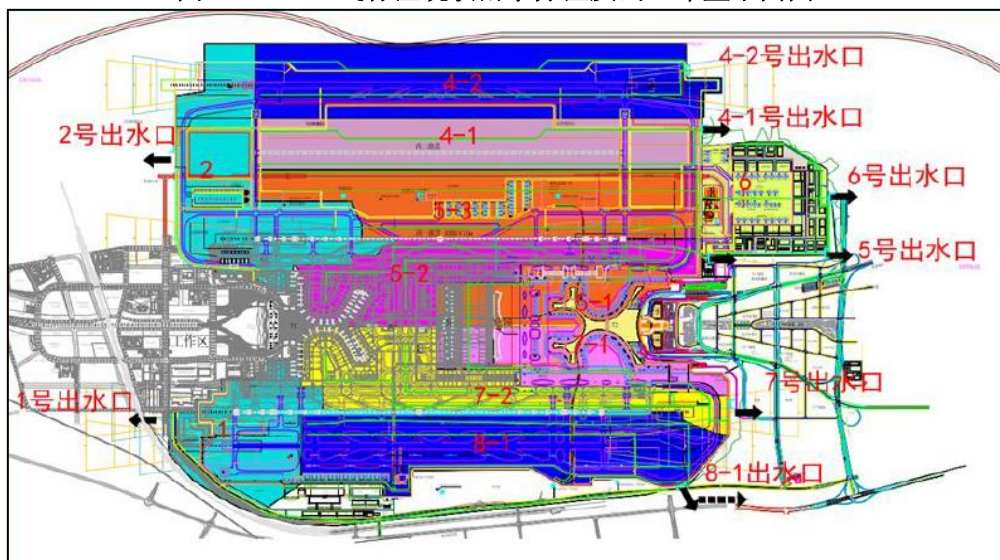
本期扩建飞行区雨水分区及出口布置平面图
